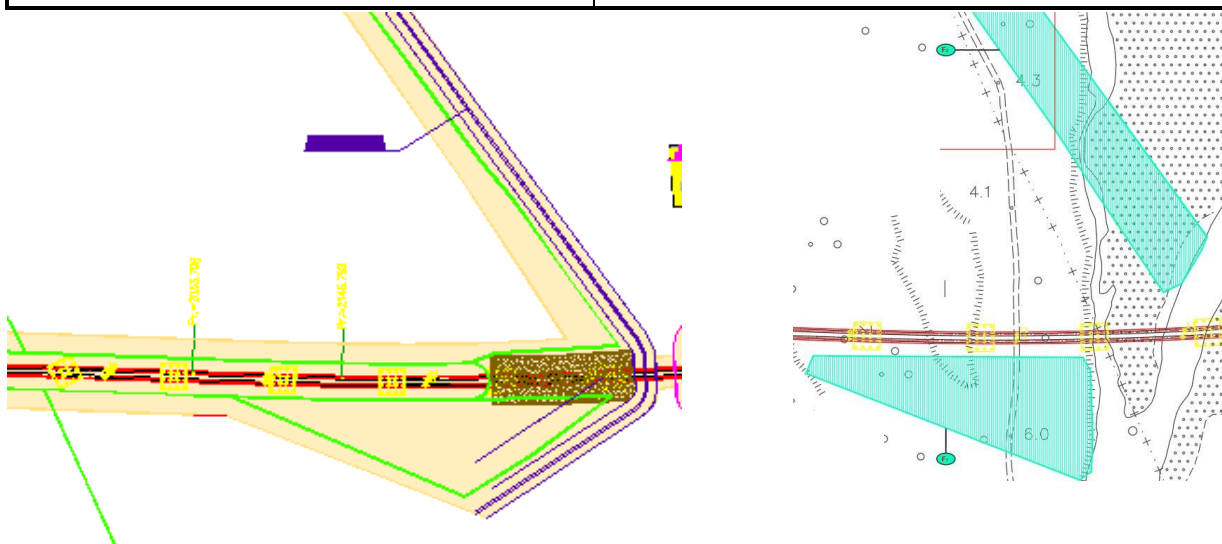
A sinistra: Stralcio planimetrico della cantierizzazione per il tracciato di progetto Variante Isonzo; a sinistra aree di intervento tipologico F
